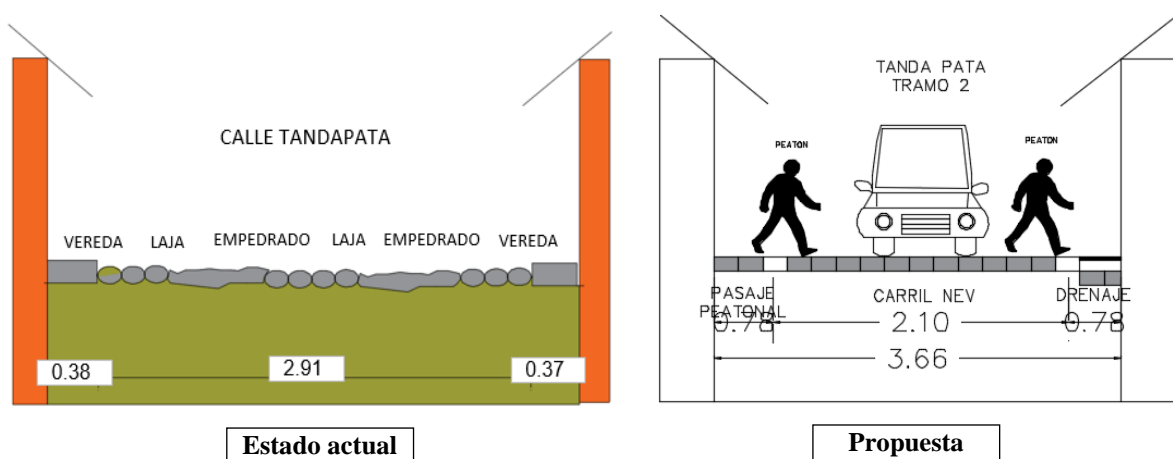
Propuesta de la sección transversal para la calle Tandapata 2
